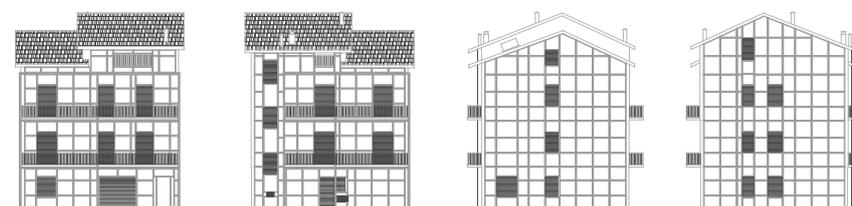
Vista delle facciate con installazione della struttura a telaio del cappotto DUO SYSTEM
